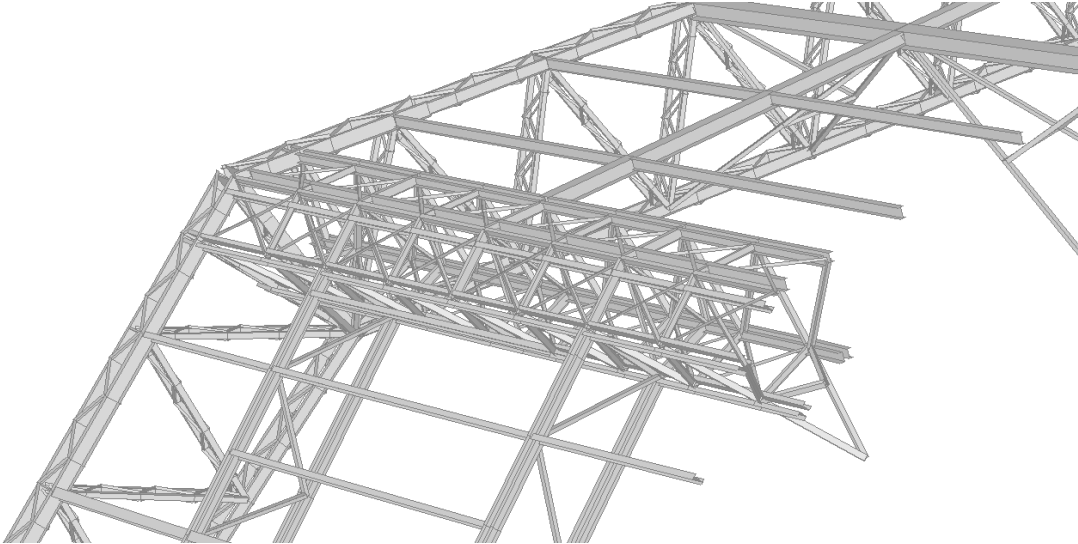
Pormenor – Ligação Arco Meridiano com Viga Triangulada (Anel Intermédio).
